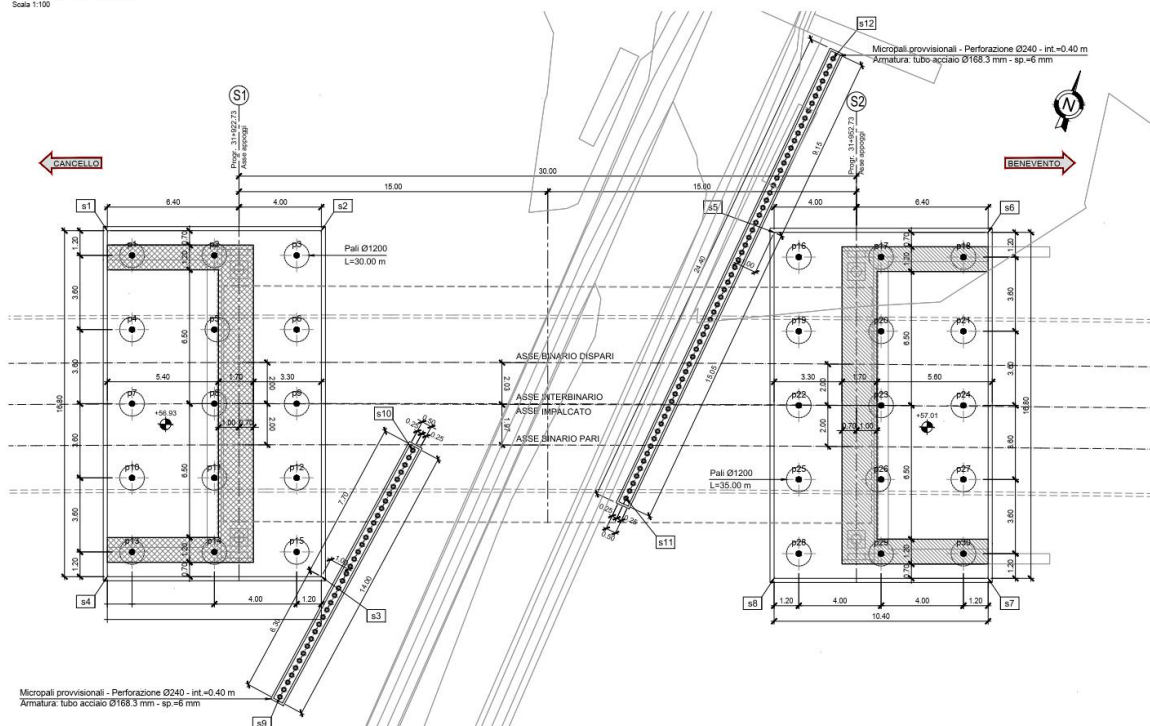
Pianta delle fondazioni del Viadotto Rio Capuano – VI12
